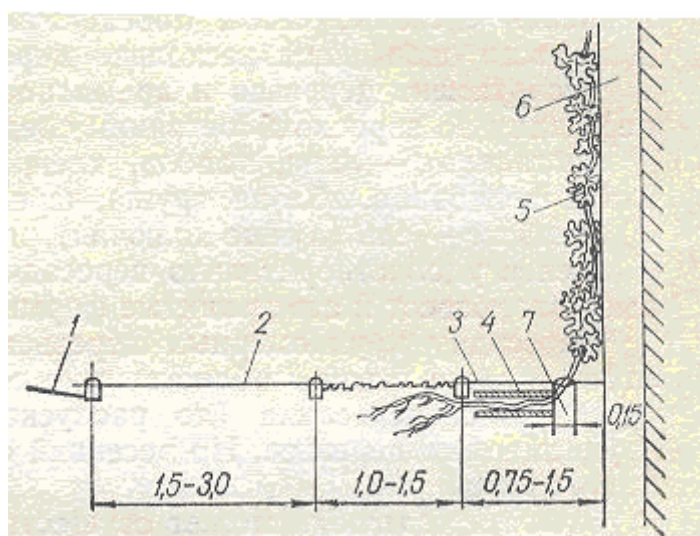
Посадка вьющихся растений у зданий с отмостками:
